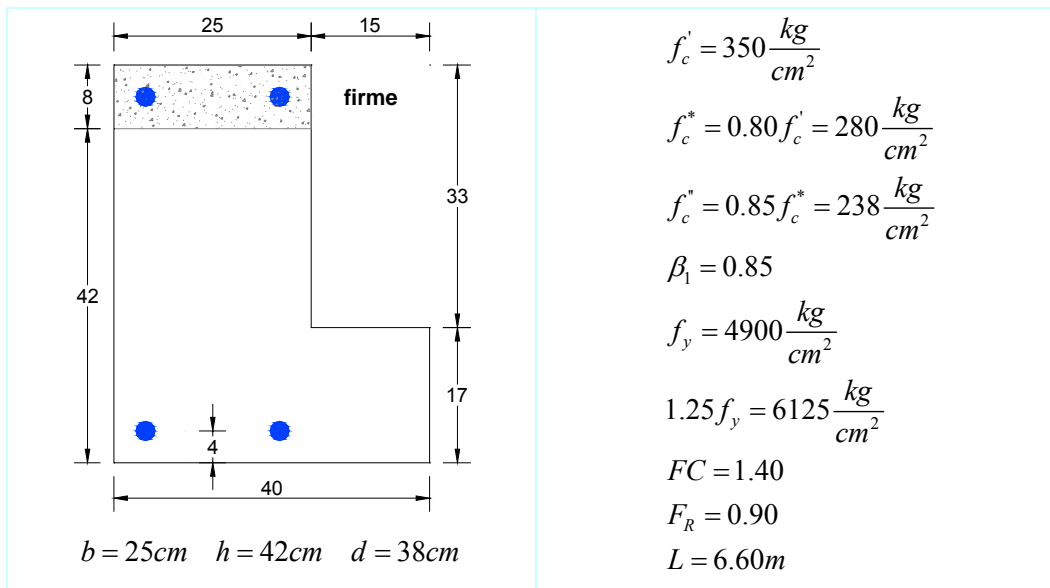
Sección transversal de la viga V25x50 (dimensiones en cm)
